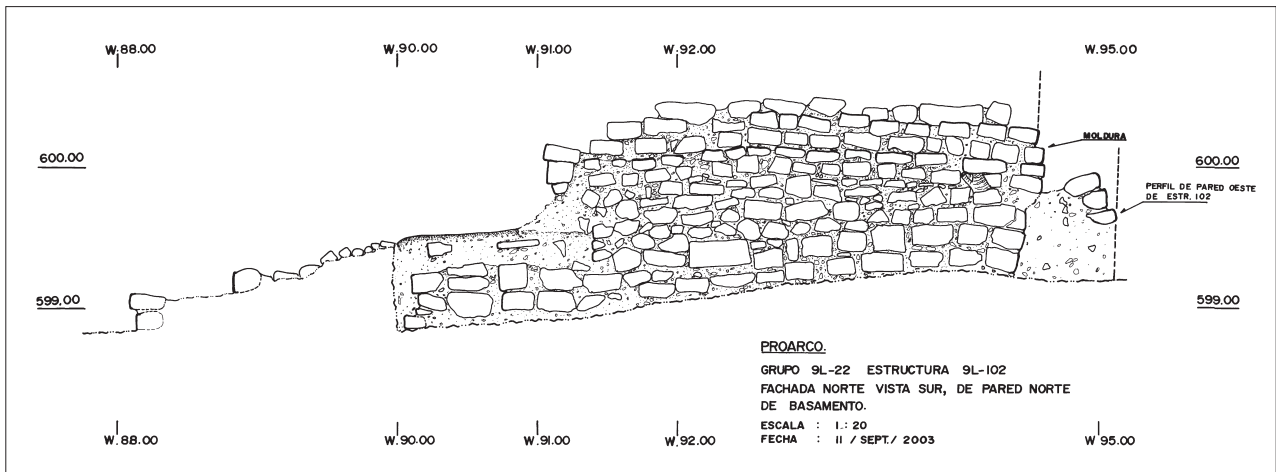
Fachada norte, vista al sur de la pared norte del basamento
